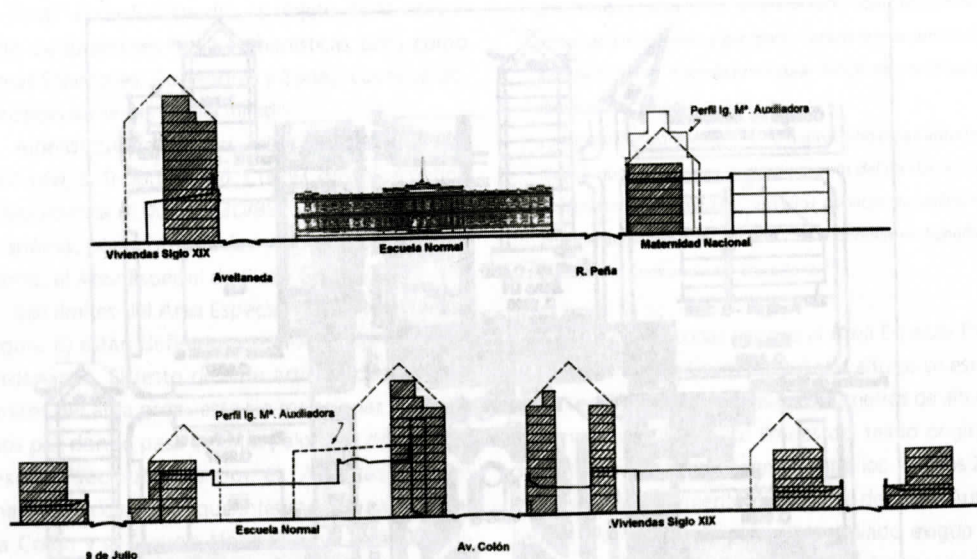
O.Nº 8057/85. Perfiles existentes y propuestos Área Especial Plaza Colón.
